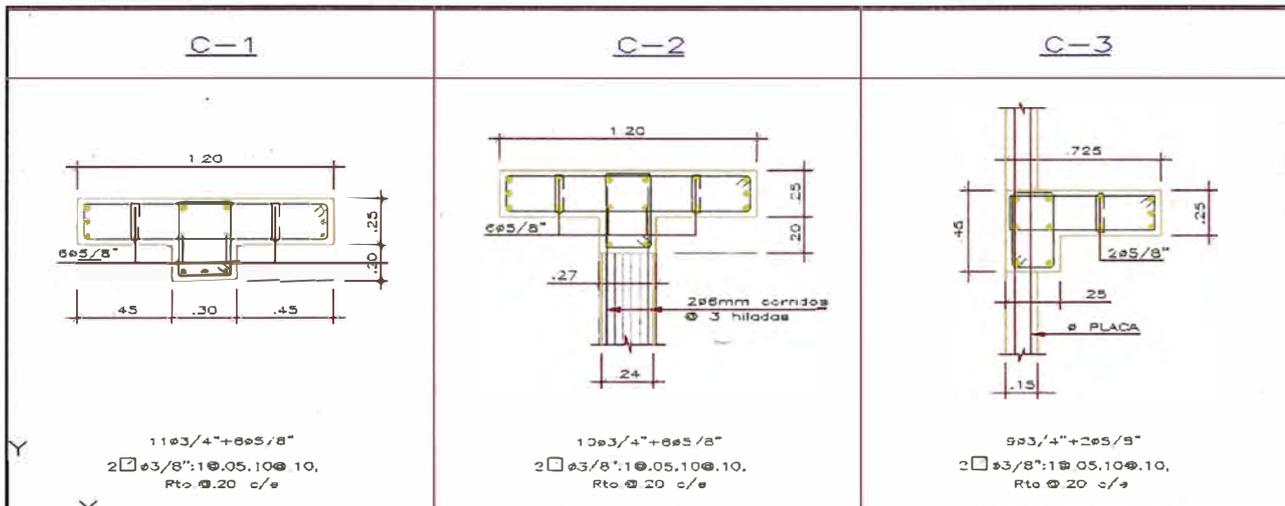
Columnas típicas en I.E. Esther Cáceres Salgado
